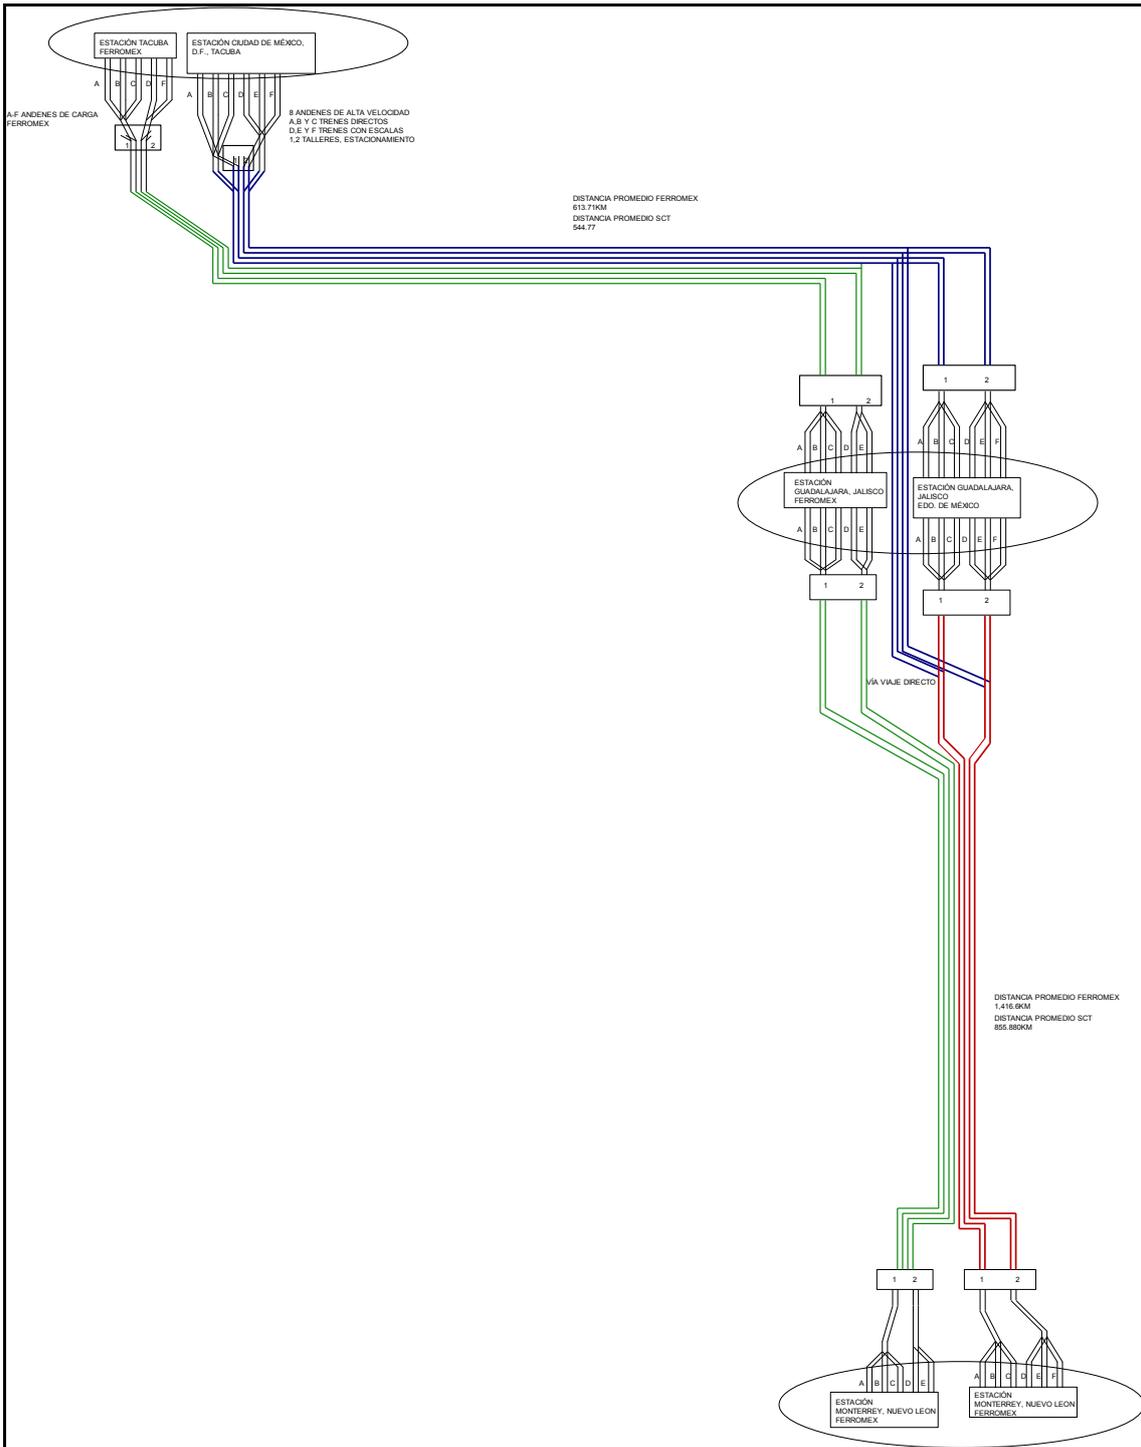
Plano de enlace de las 3 estaciones principales
